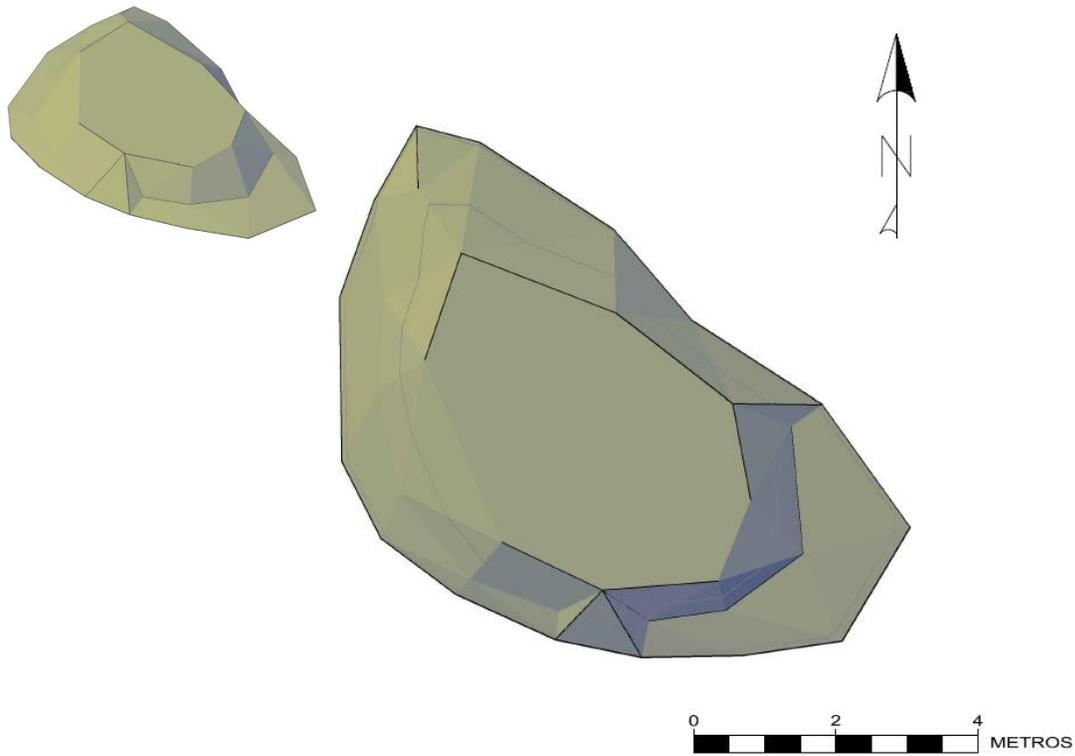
Perspectiva y vista de planta de la Plataforma 2.
